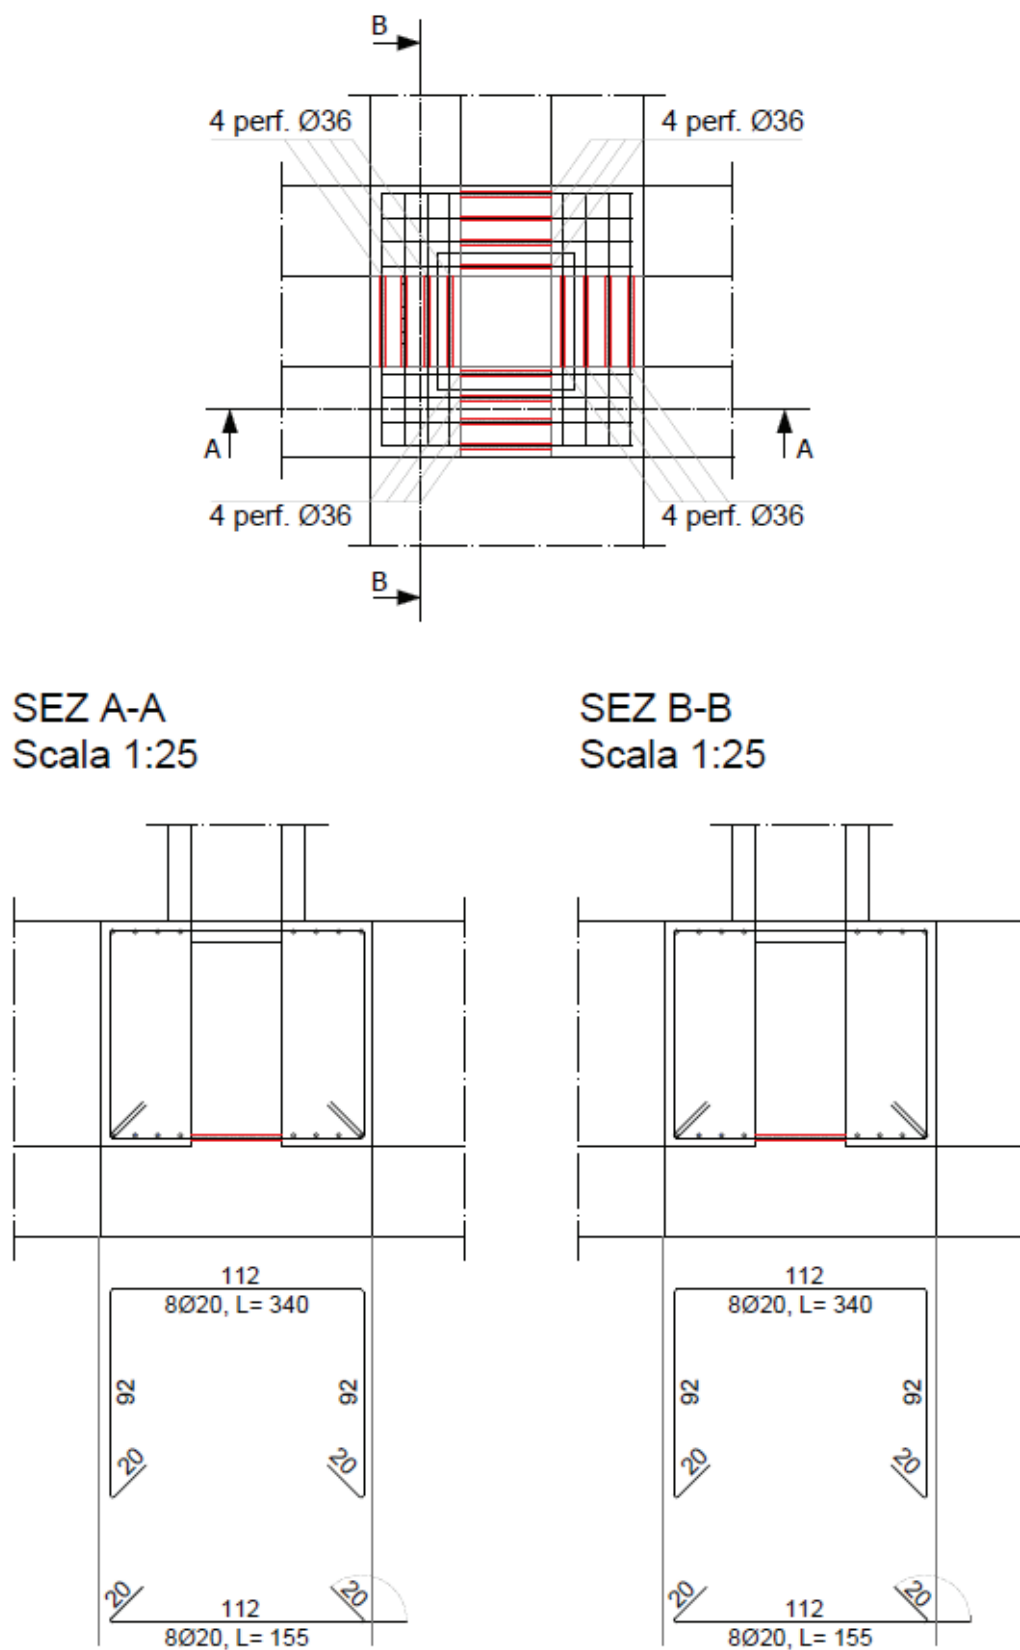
Intervento in fondazione – Plinti in corrispondenza dei pilastri ringrossati
